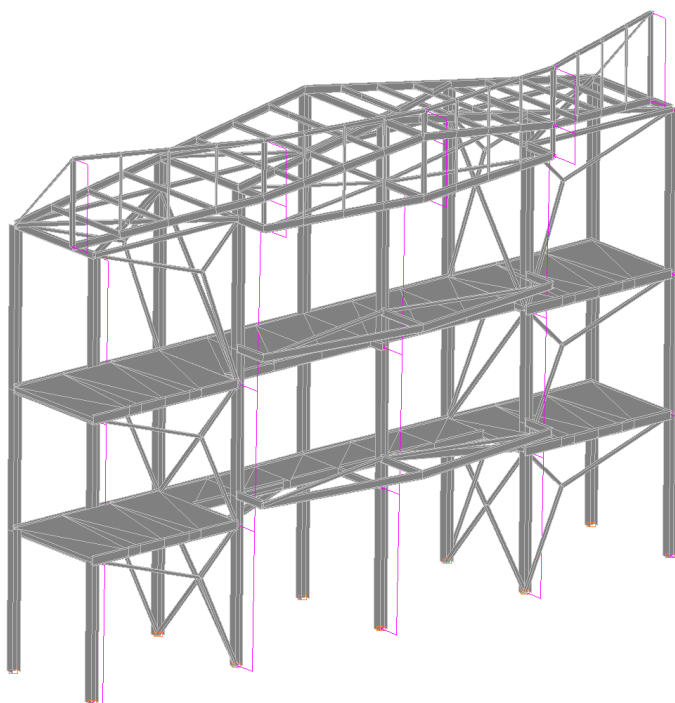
Нагрузка на каркас от ветровой нагрузки
